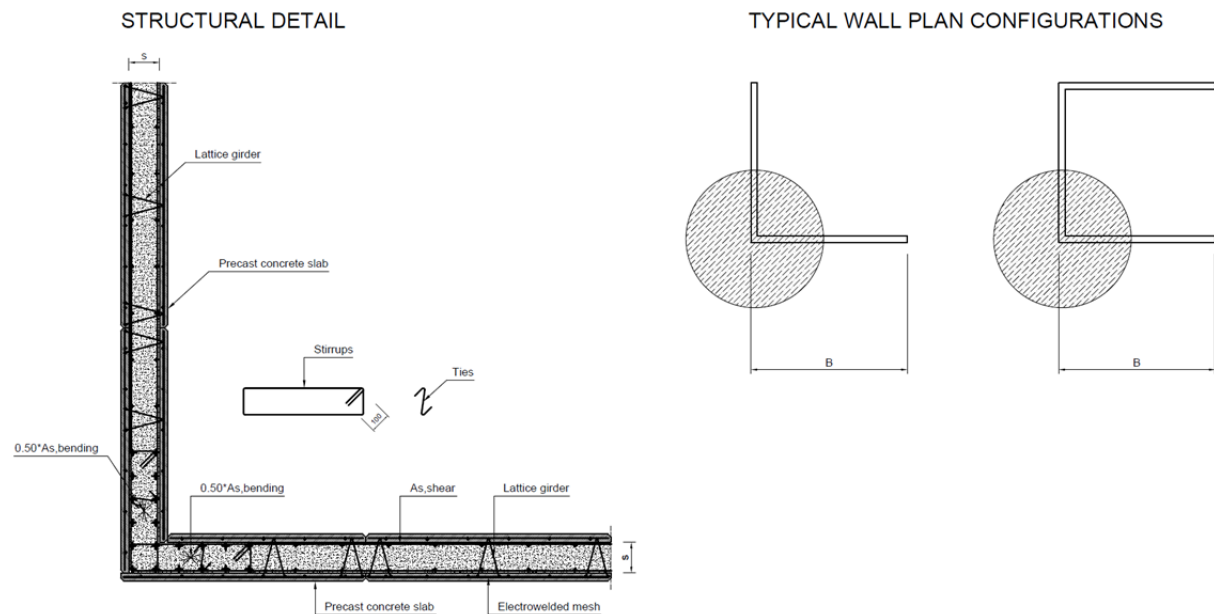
Exemple de détail de structure d'angle pour murs de contreventement BA et vues en plan usuelles.
